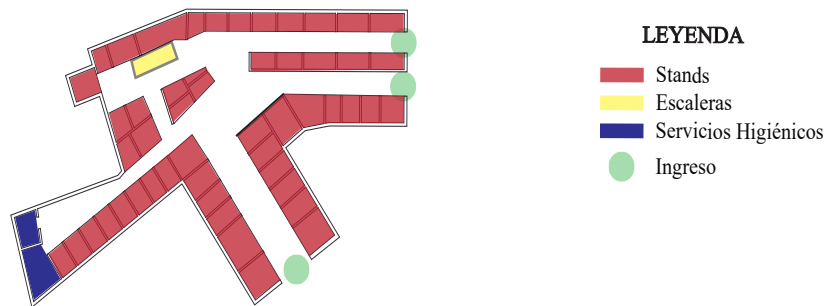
Plano de distribución de la galería analizada Mesa Redonda.⁸¹
